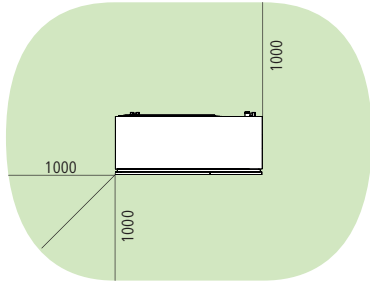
Zona di protezione: installazione davanti a un edificio [mm]
